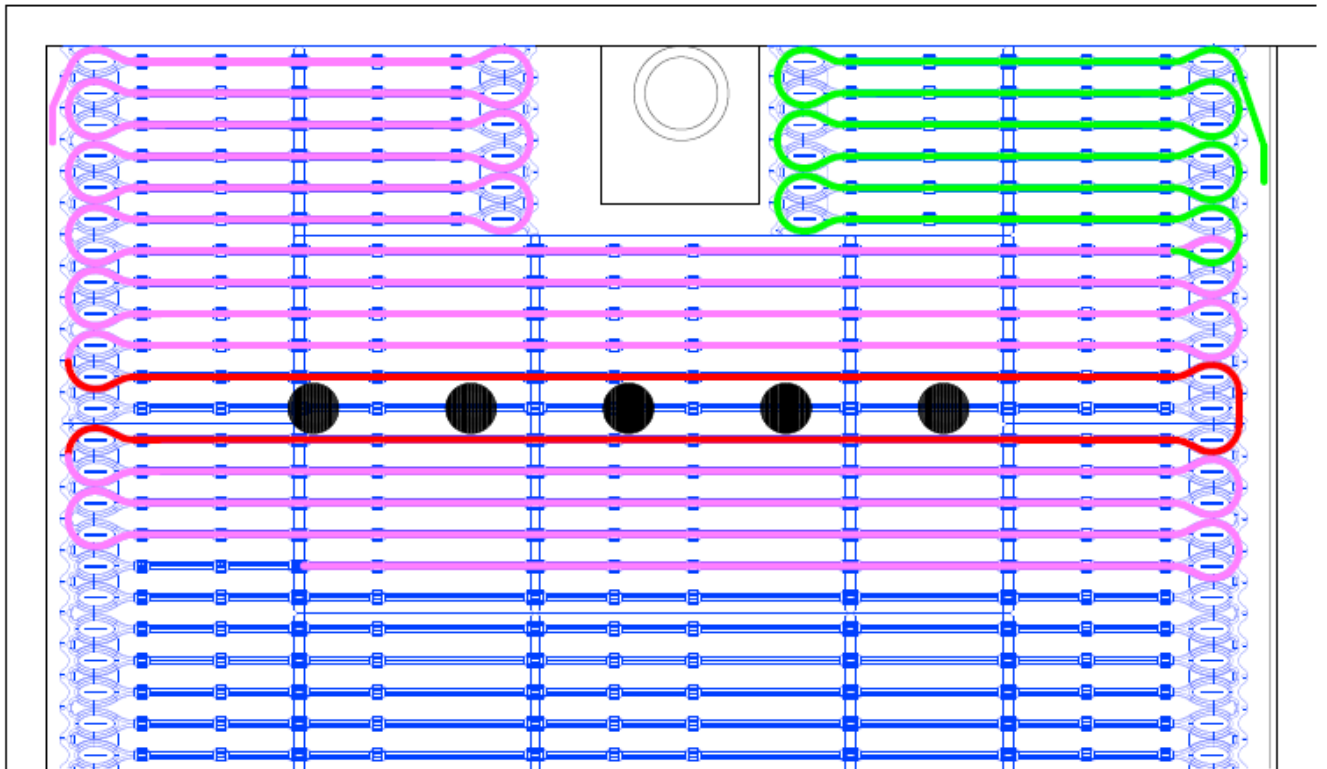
Zoom sur plan de pose des tubes (présentation de la modularité dans le cheminement du tube)
